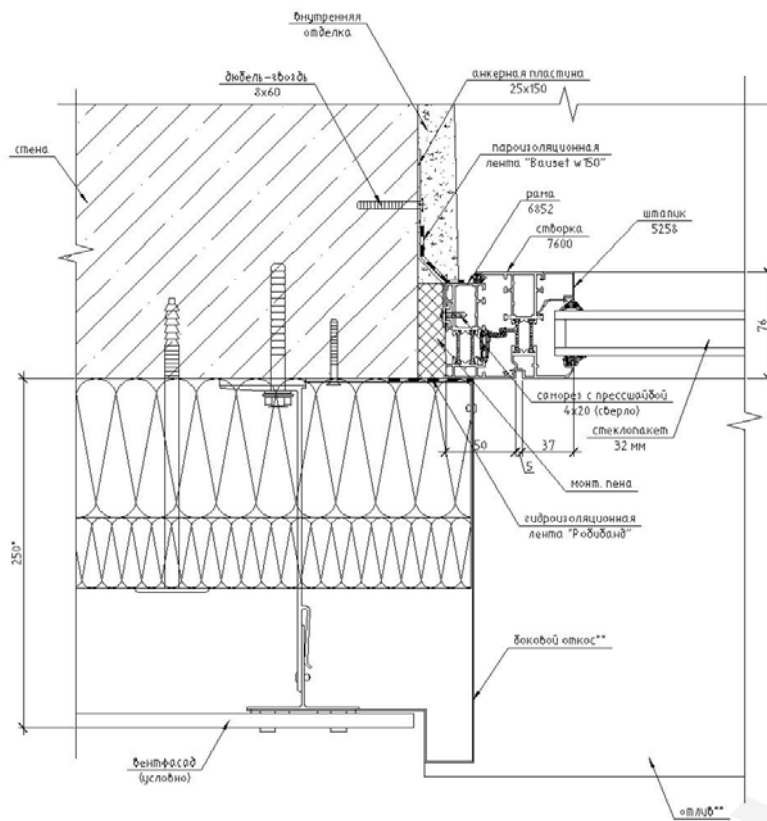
Боковой узел примыкания оконного блока к бетонной стене.
